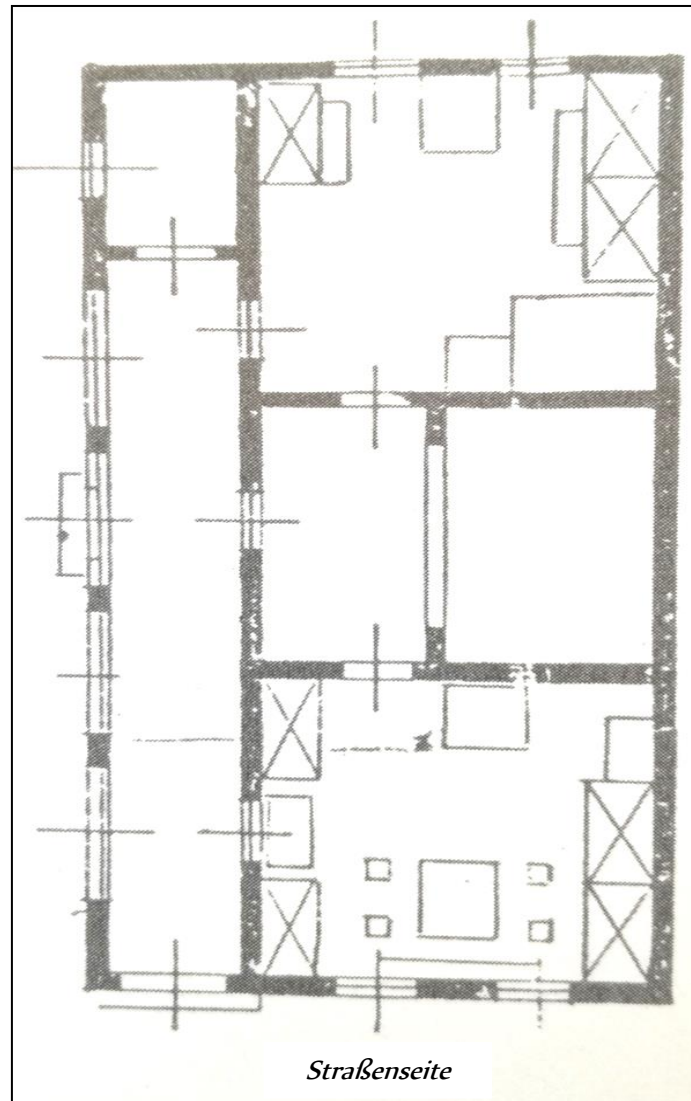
Grundriss eines Wohnhauses;
